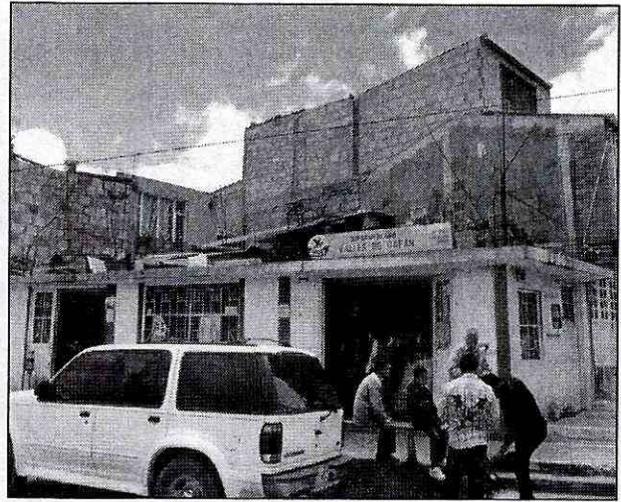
Ampliación constructiva de la viviendas, nótese que son 4 niveles y hacia la zona posterior de la vivienda
